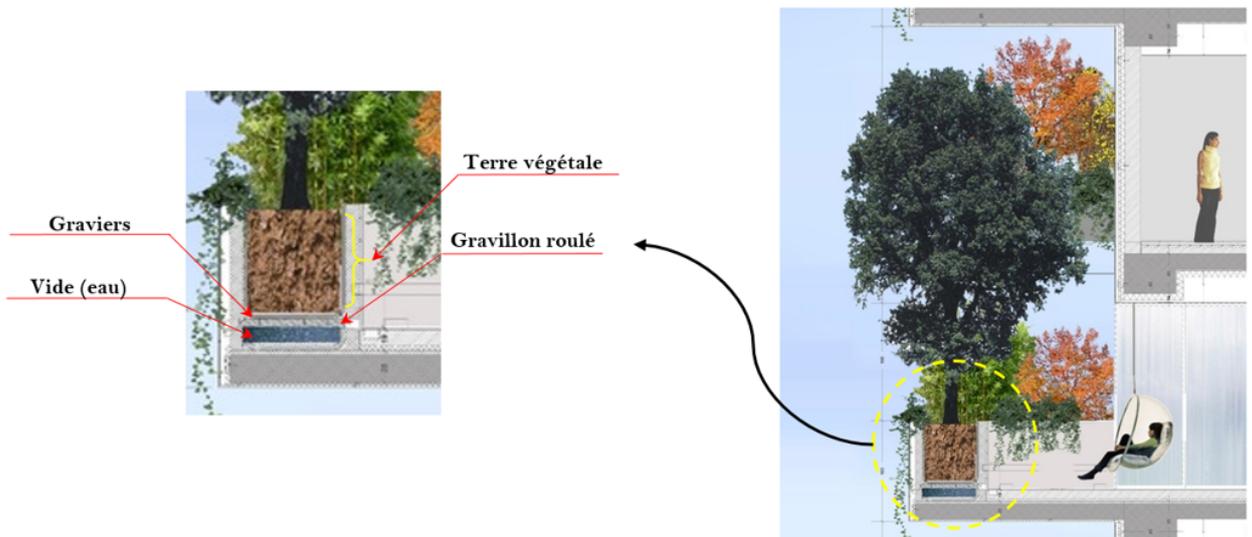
Schéma explicatif d'un bac sur dalle.
